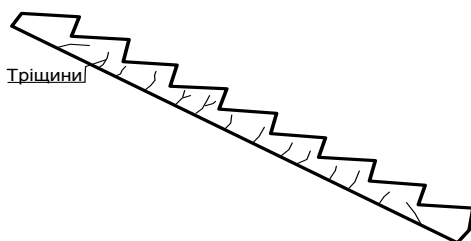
Розташування тріщин у бетонній основі сталезалізобетонної плити сходового маршу
